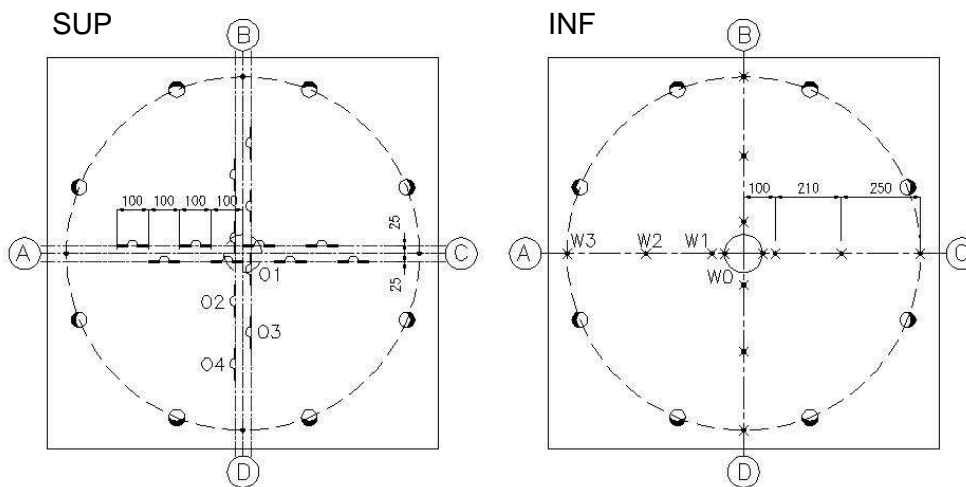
Disposition des instruments de mesures sur les dalles d'essai.
